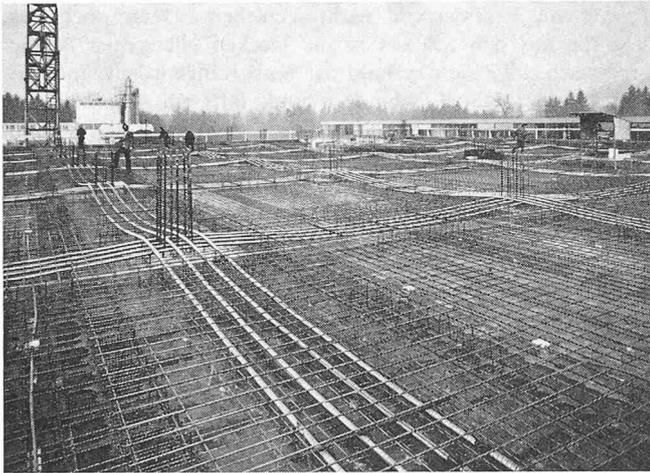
Bewehrungsbild mit verlegten Spannkabeln. Lagerhaus Schöntalhof, Ruppertswil, März 1973
